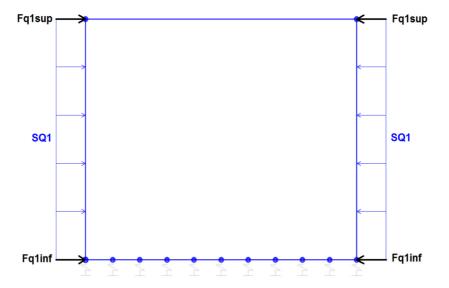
Condizione di carico SPACCSX e SPACCDX da SAP2000
